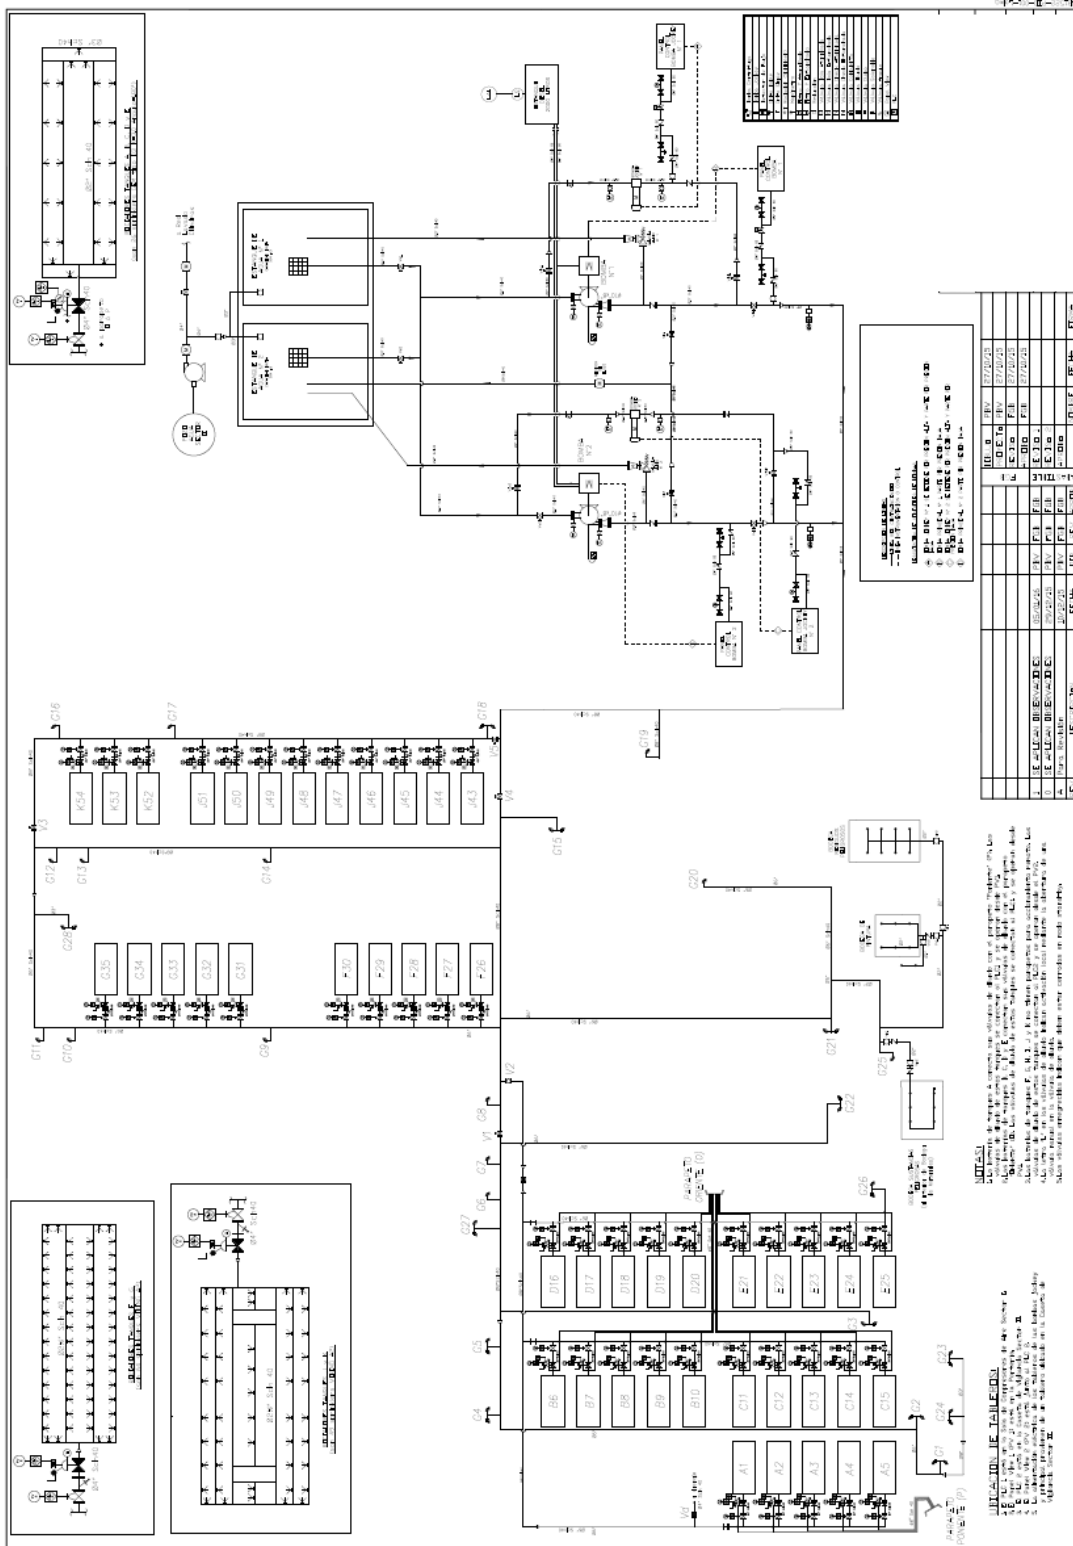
Plano hidráulico planta. Fuente: Empresa.
